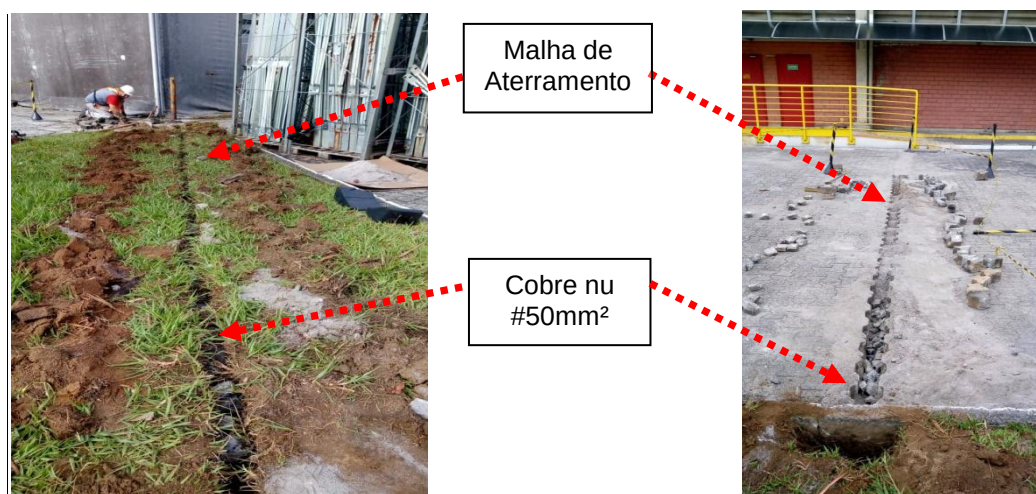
e 173: Interligação de estruturas metálicas a malha de aterramento existente
